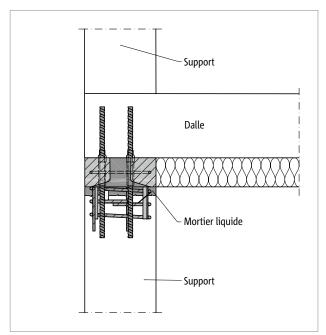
Schöck Sconnex® type P : raccordement d'un poteau de bord à la dalle sus-jacente
